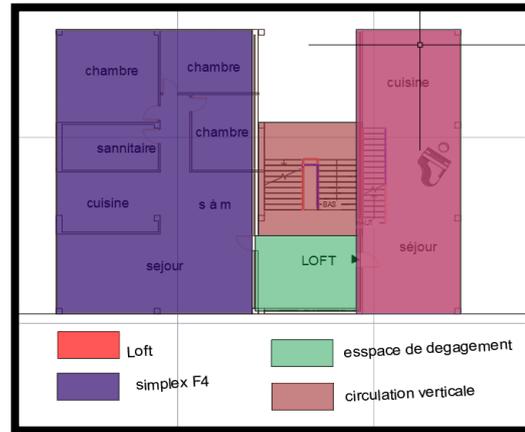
plan du 14eme au 17eme étage (source : auteur).
